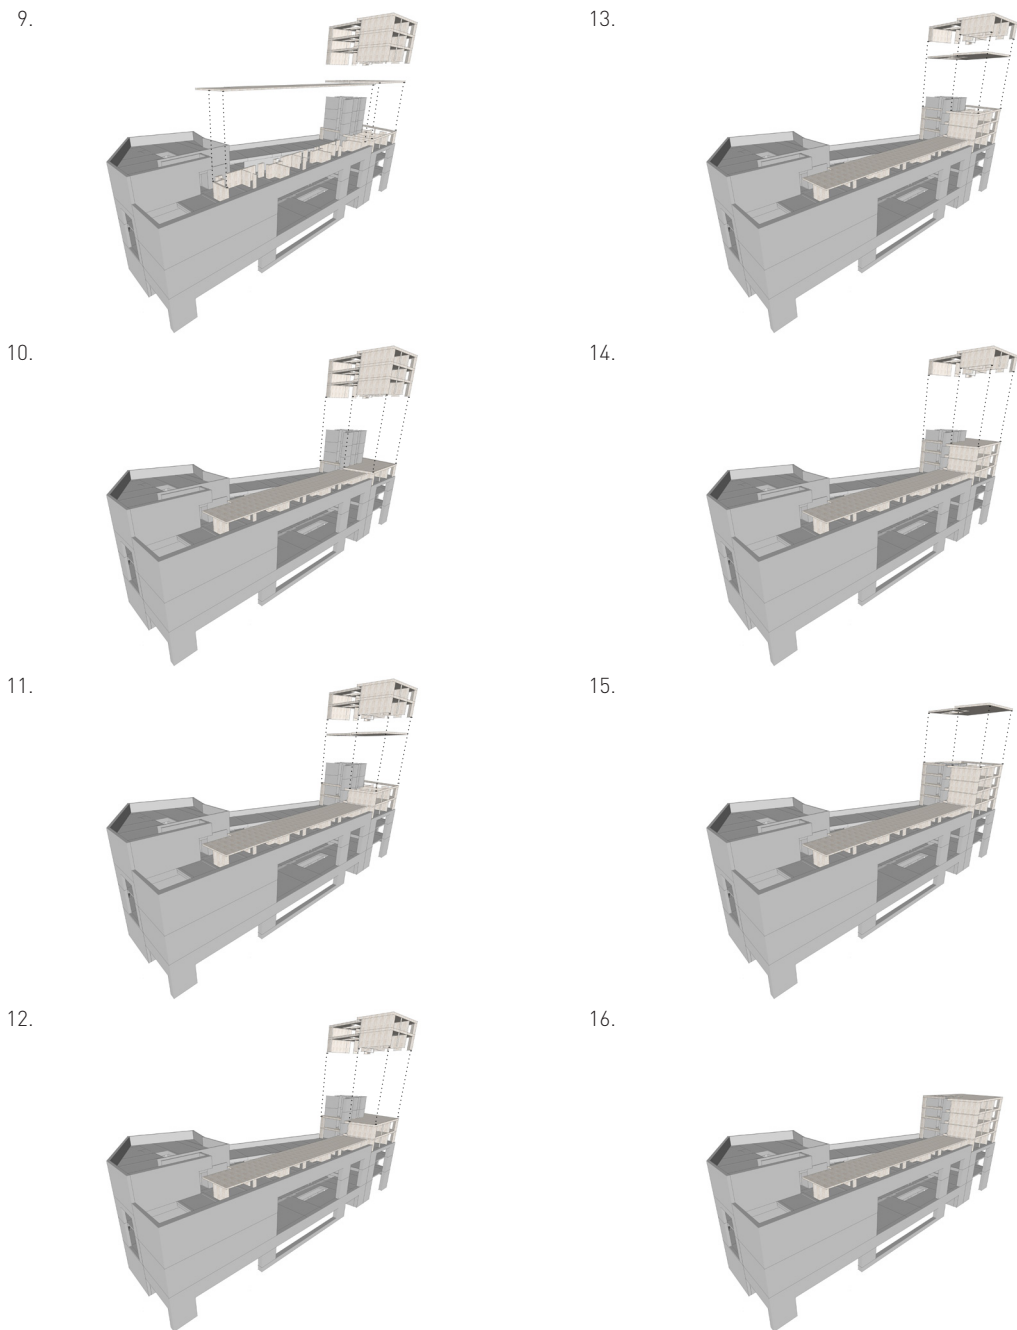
statisches Tragsystem Holzbau (Brettschichtholz)
